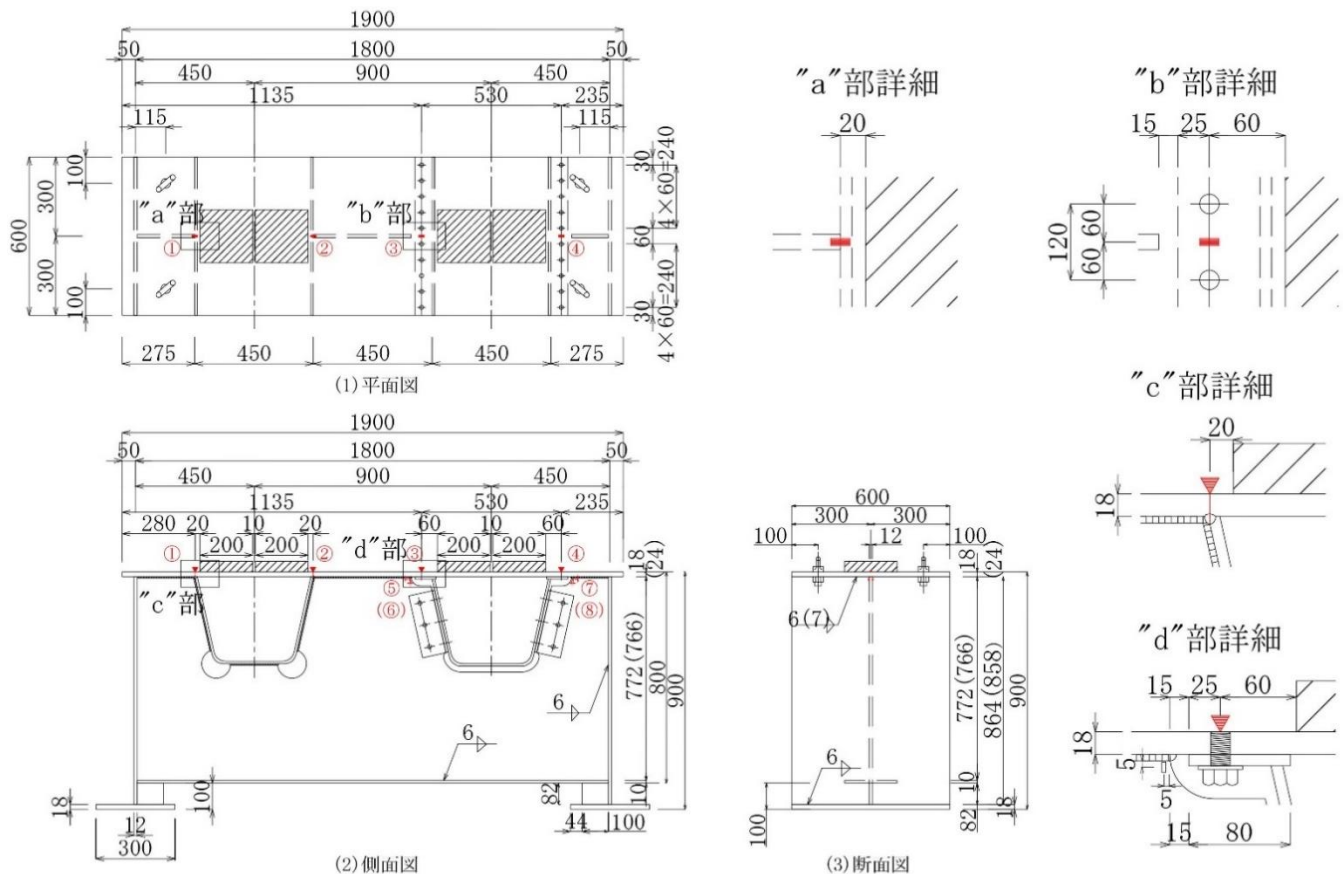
試験体の形状と寸法、荷重位置、ゲージ位置
